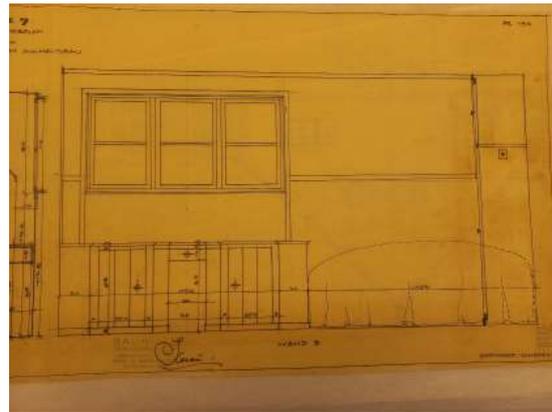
Schlafraum im Dachausbau.Einrichtungssplan. Wand B
